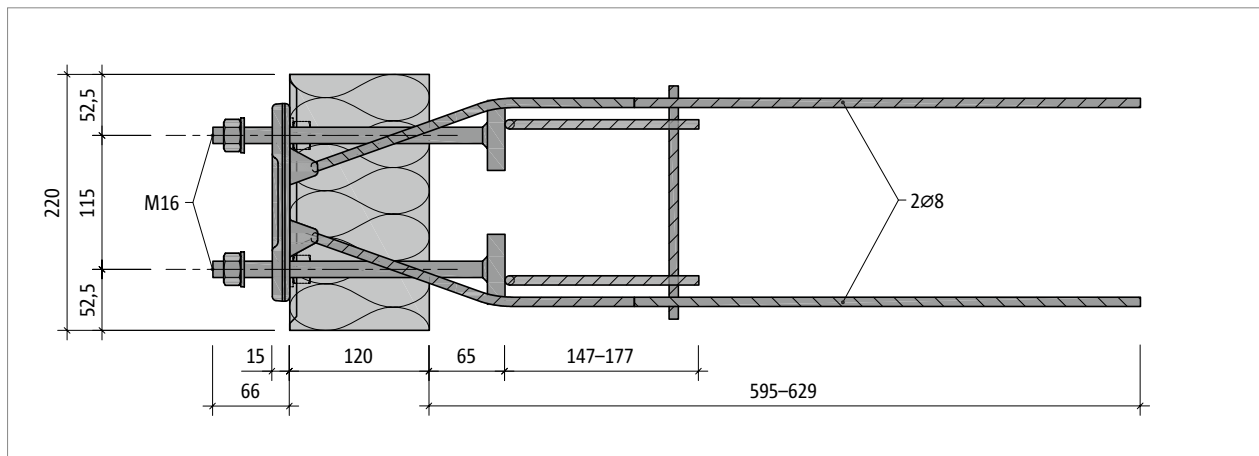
Schöck Isokorb® XT type SQ-V1 : vue en plan
